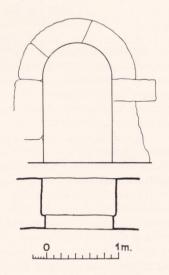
und 380. Grundriss und Schnitt. — Maßstab 1:300. Abb. 381. Aufriss und Schnitt der Ture zum ehemaligen Schiff. — Maßstab 1:50.
